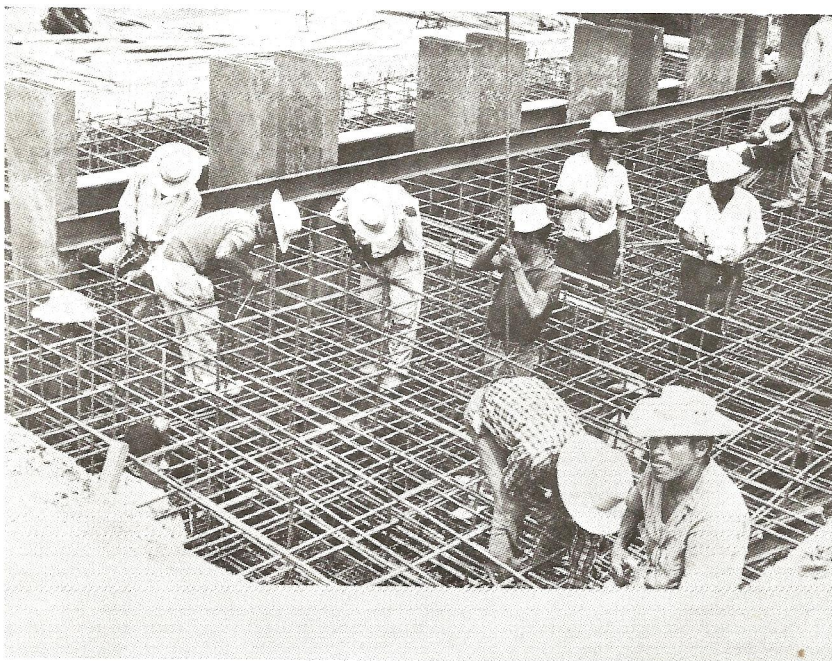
Vista parcial de la construcción de un banco de preesfuerzo en Guatemala. Armado de los masivos.
